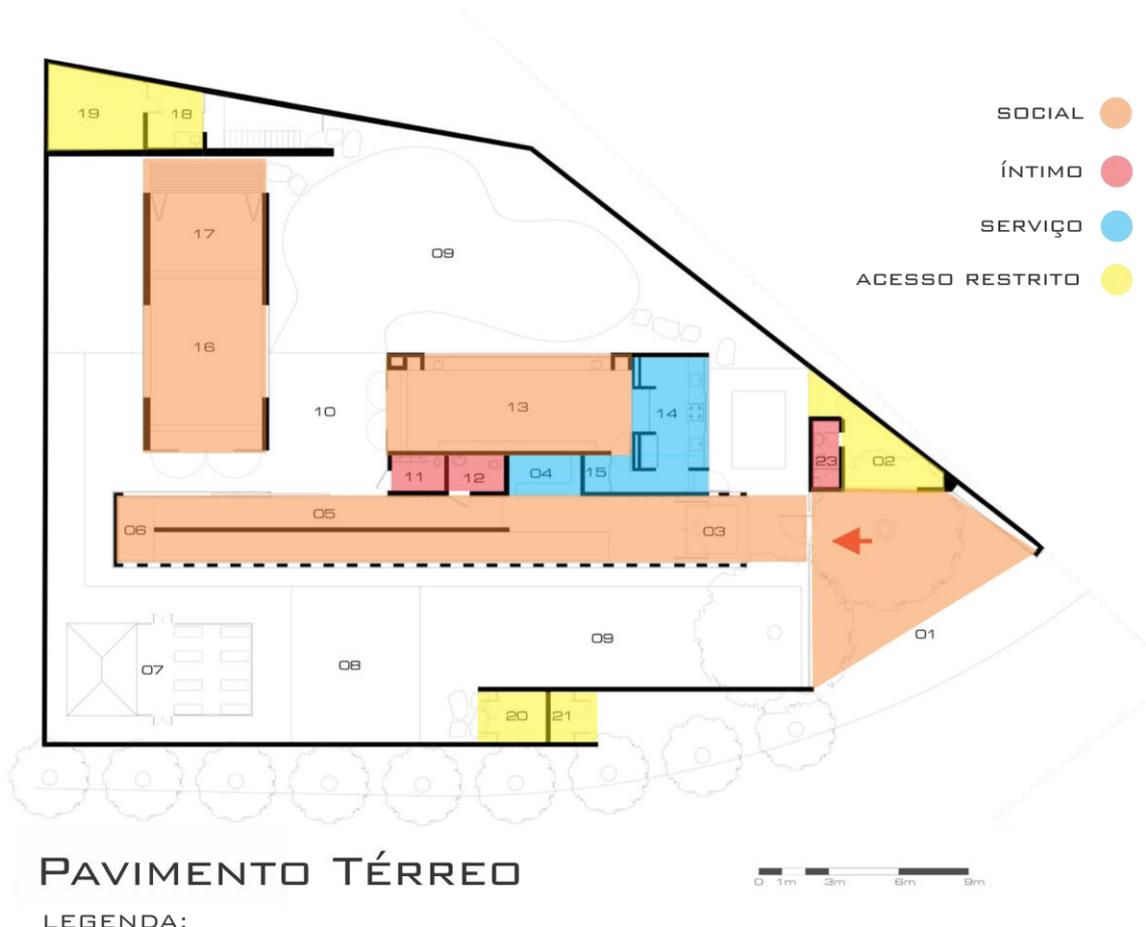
Setorização pavimento térreo (adaptação e tradução da autora).
